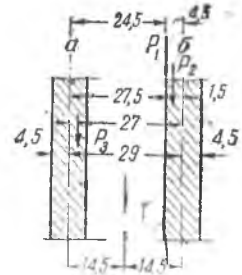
Распределение нагрузок между наружной (а) и внутренней (б) стенками
